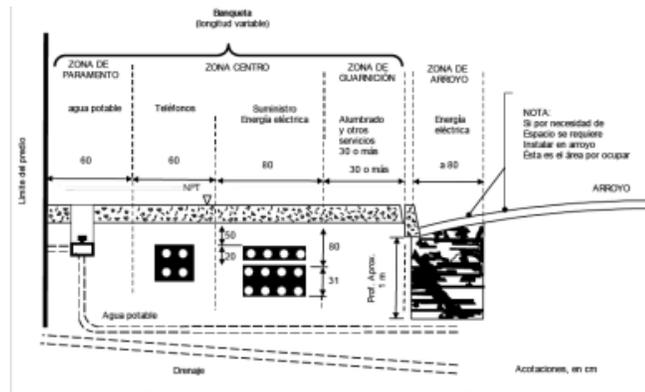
Zonificación recomendada de instalaciones en banqueta
